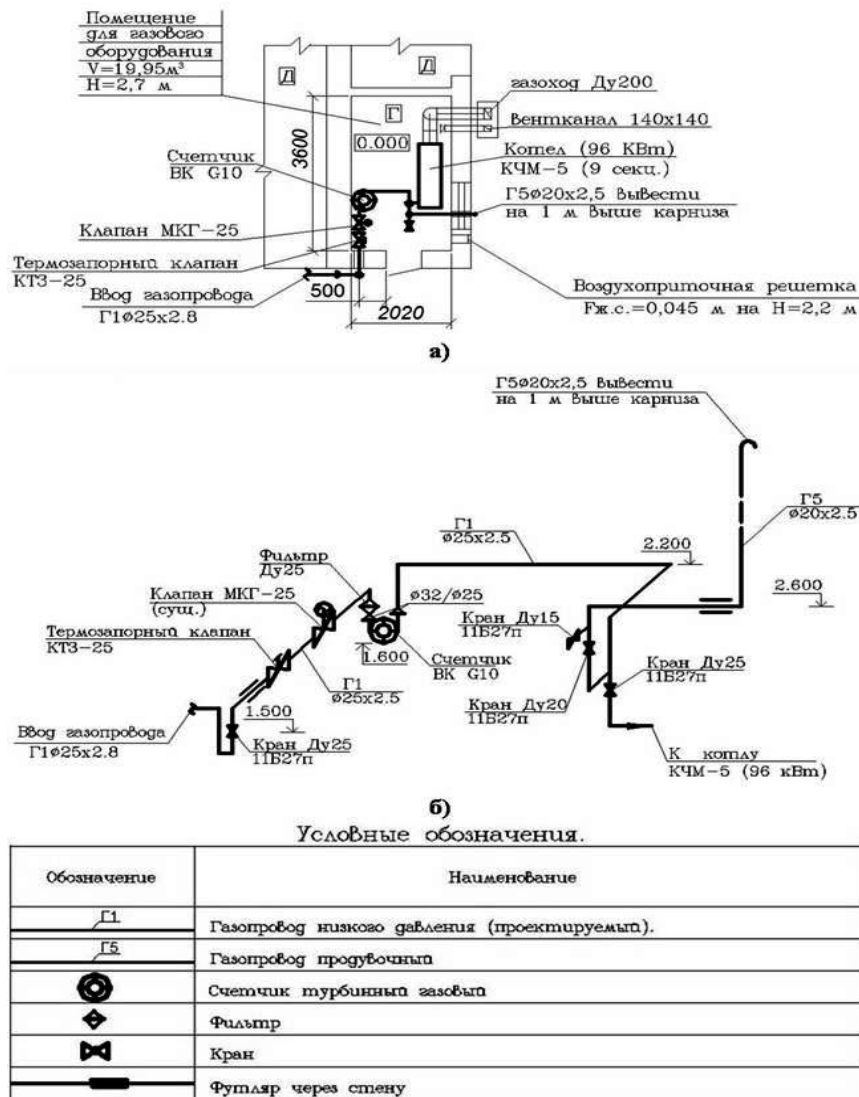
Проектируемые наружные газопроводы: а – план на отметке 0.000; б – схема газопроводов
